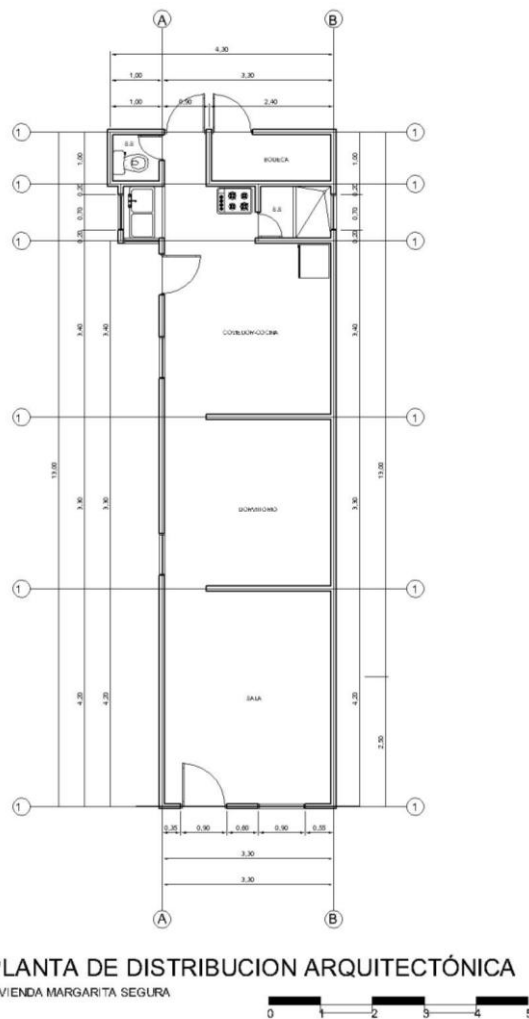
Vivienda Margarita Segura. Planta Distribución.
